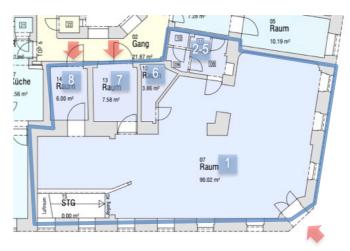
Grundriss Top 5 (Erdgeschoss)
